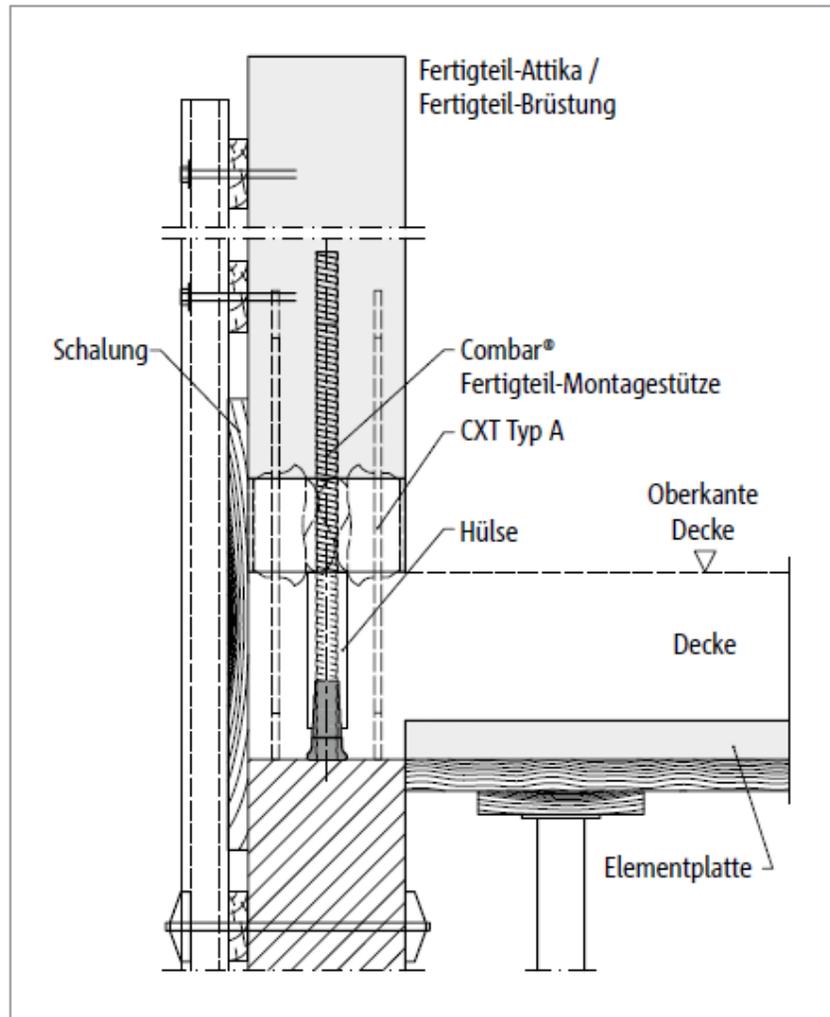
Schöck Isokorb® CXT Typ A: Anschluss einer Brüstung
